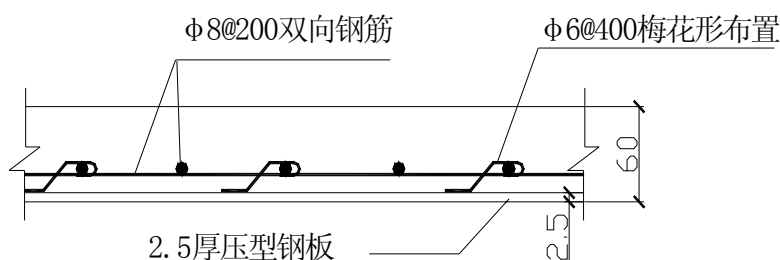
看台板内钢筋与压型钢板连接形式示意图
